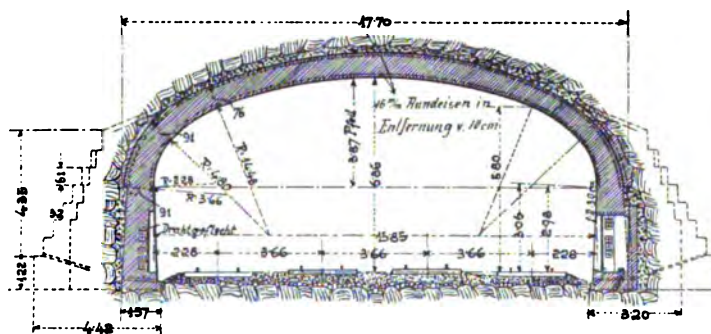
Querschnitt des Marble Hill-Tunnels.
